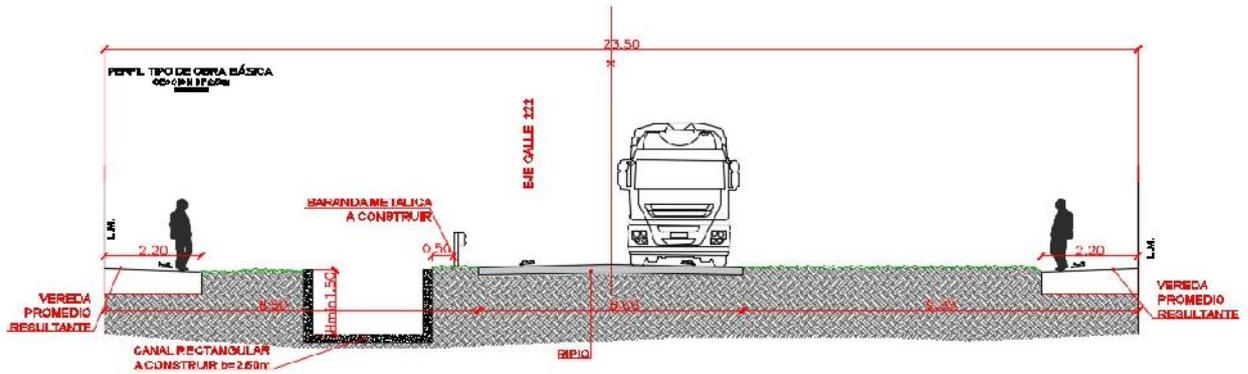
Perfil Tipo de Obra Básica. Canal Rectangular Abierto. Ancho = 2.50m
